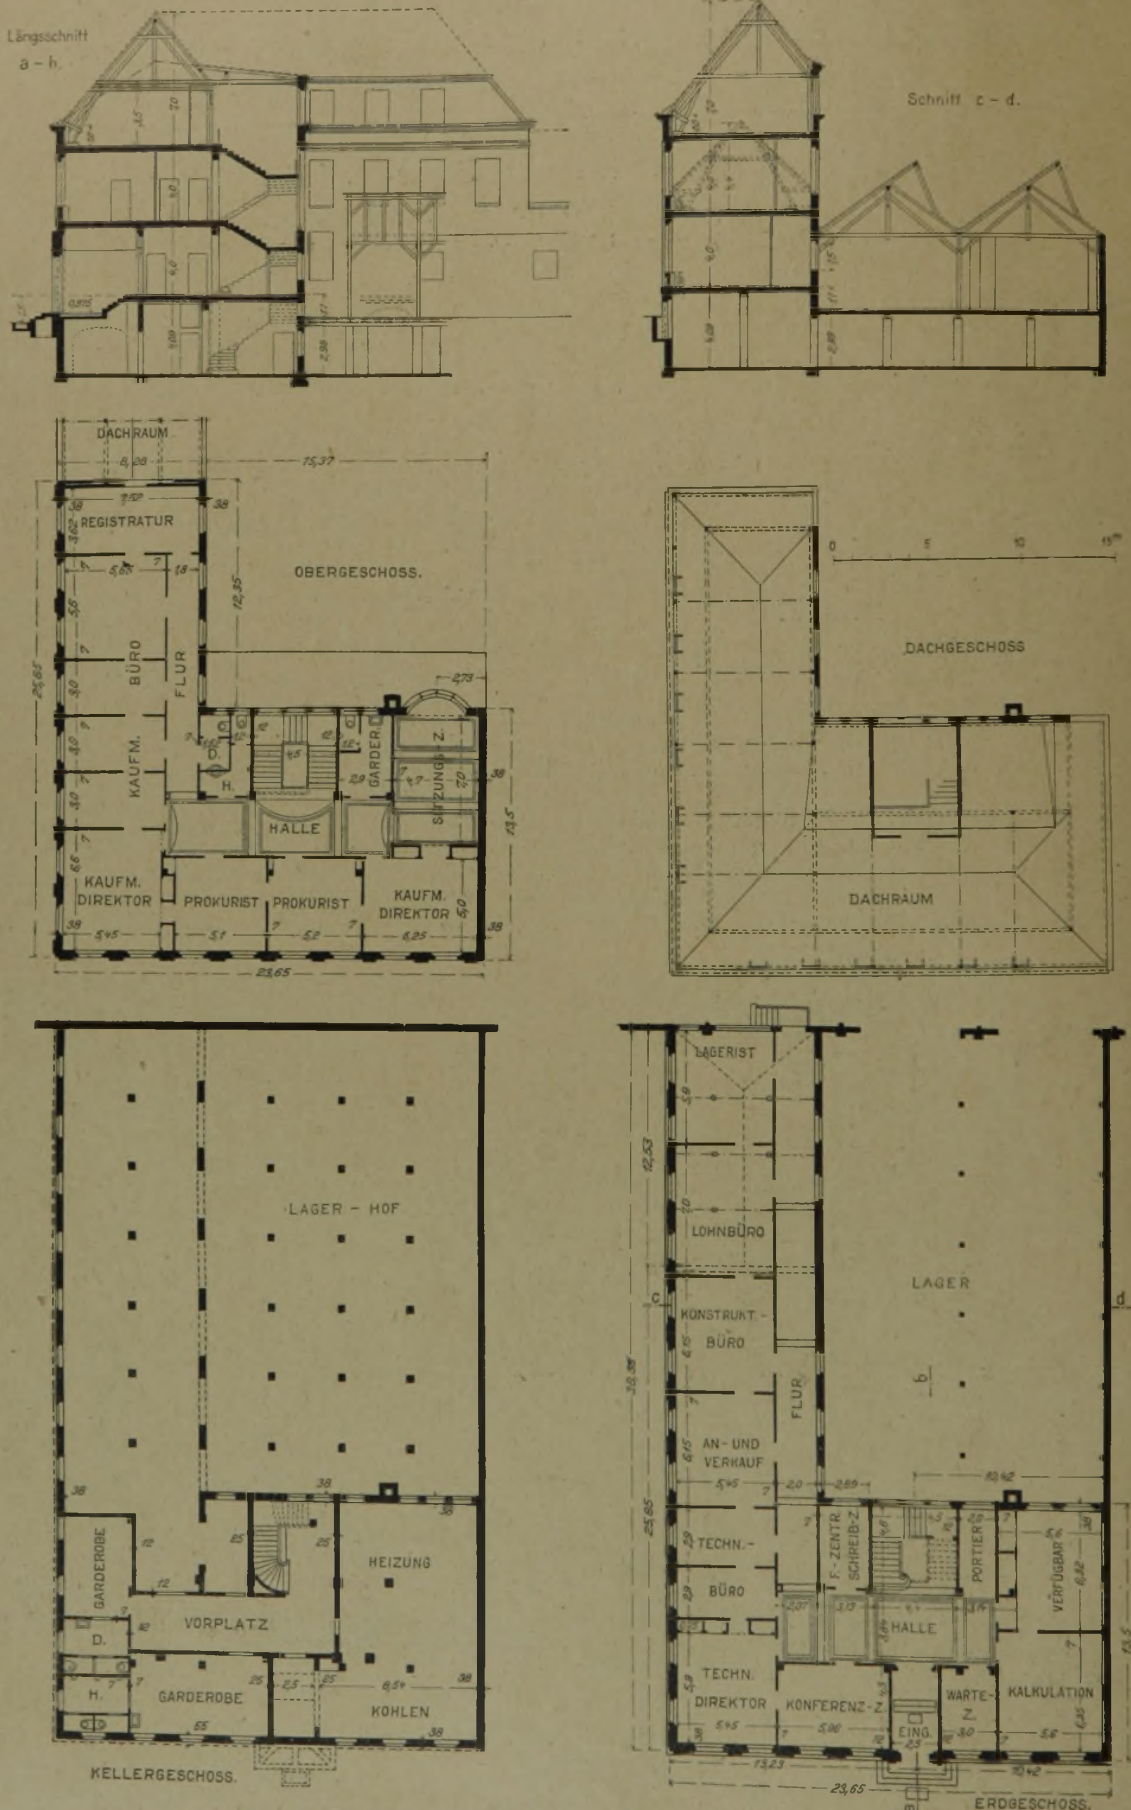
Grundrisse und Schnitte des Geschäftshauses.
